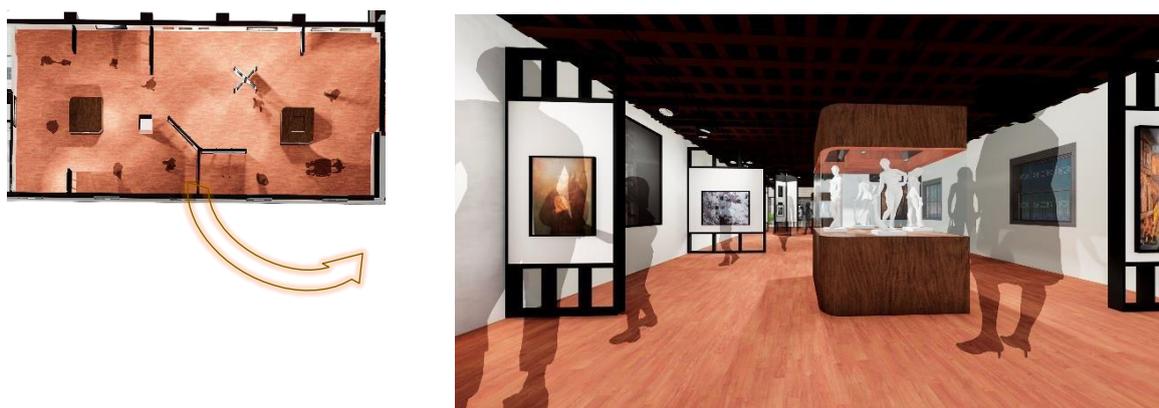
Recorrido mixto del Museo Juan Villafuerte.
